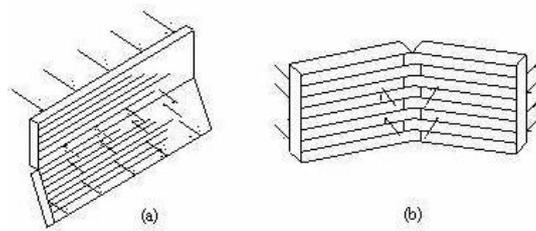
Riss des Mauerwerks bei senkrechte Biegung auf das Mauerwerksplan
